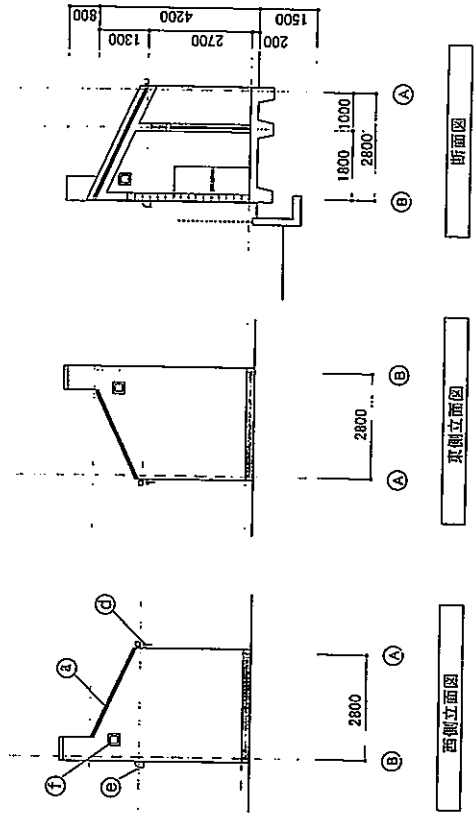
漁民ロッカ一平面図、立面図、断面図(2)
